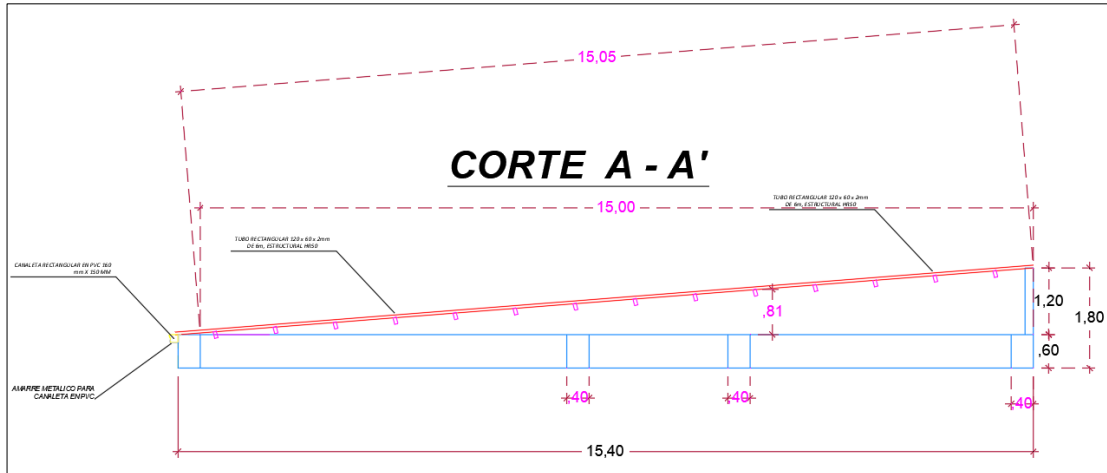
Corte arquitectónico A-A, de la estructura 2 del Centro de Desarrollo Infantil.
